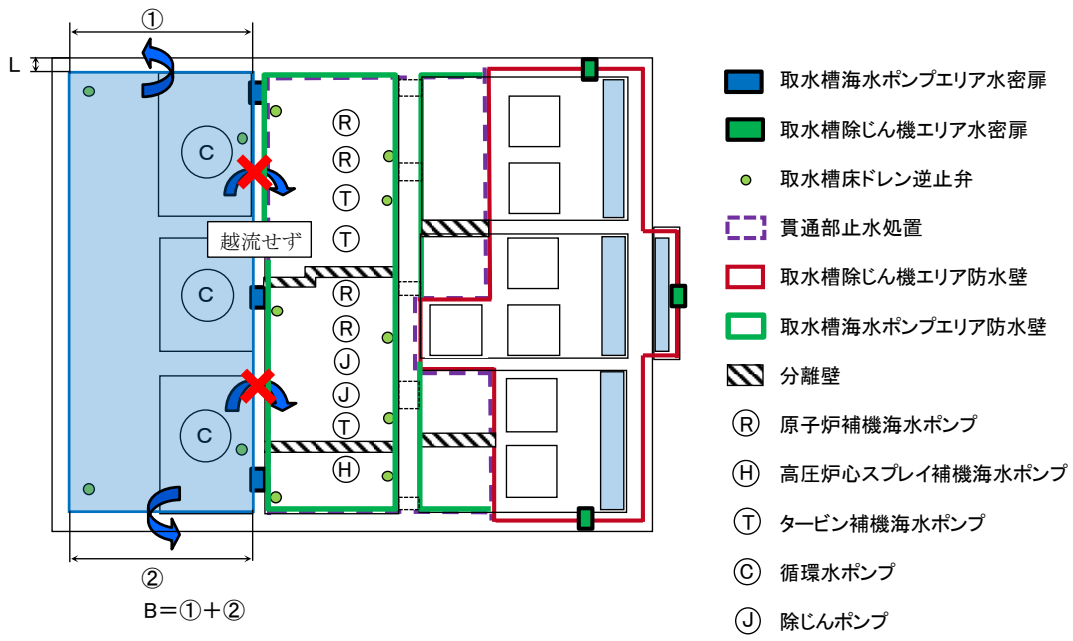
取水槽海水ポンプエリア平面図 (循環水系配管破損時)
